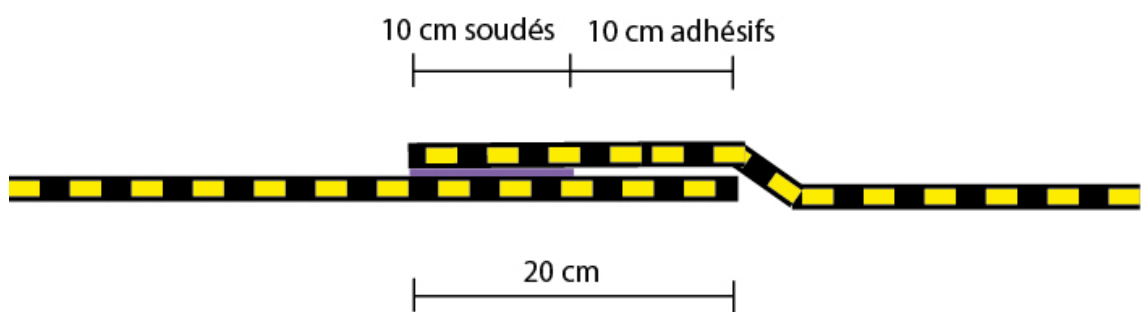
bis – Soudure des recouvrements transversaux sans écran thermique avec feuille Meps 25 L3 ADF SI
